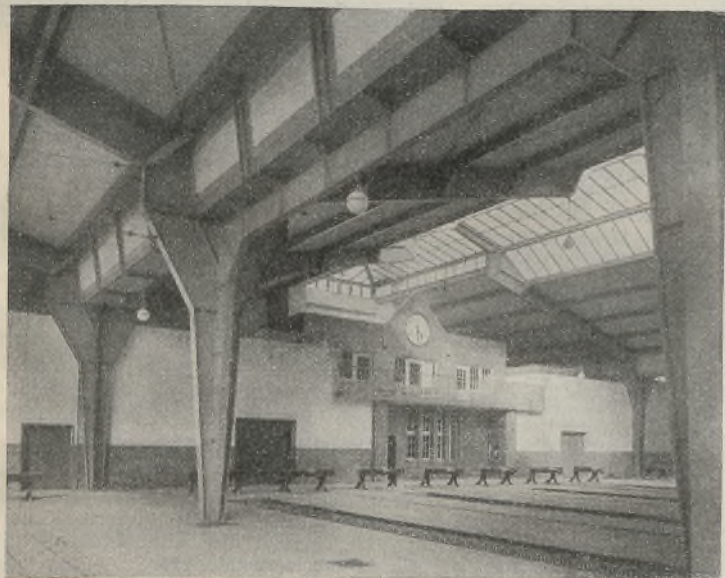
Straßenbahnhalle an der Müllerstraße, Berlin. Einzelheit der Stahlkonstruktion. (Ingenieurbureau G. Mensch, Berlin-Charlottenburg.)
